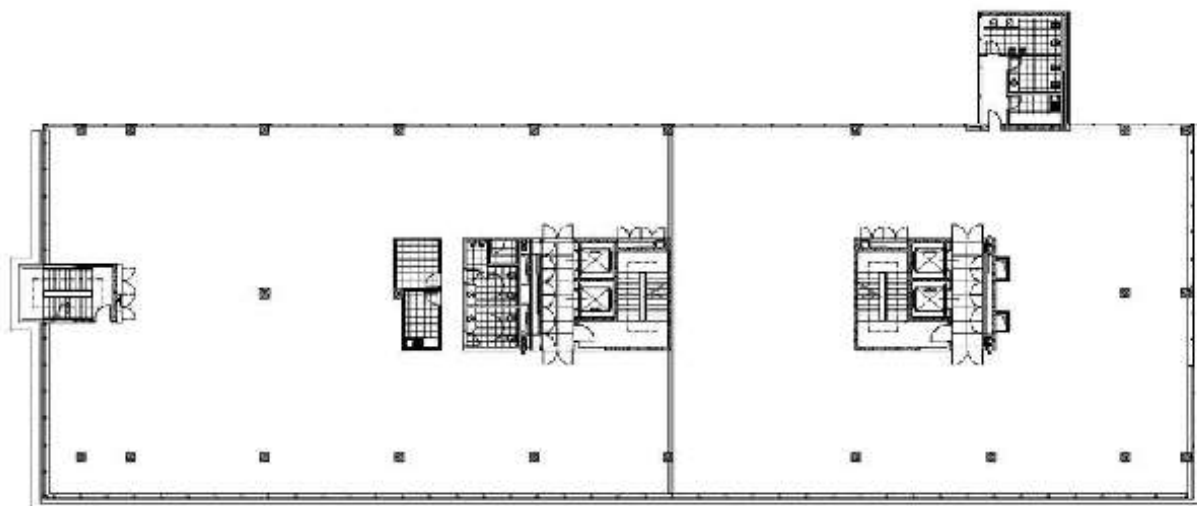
Planta Tipo do Edifício E do Complexo Alfrapark (Fonte: Alfrapark.com)
